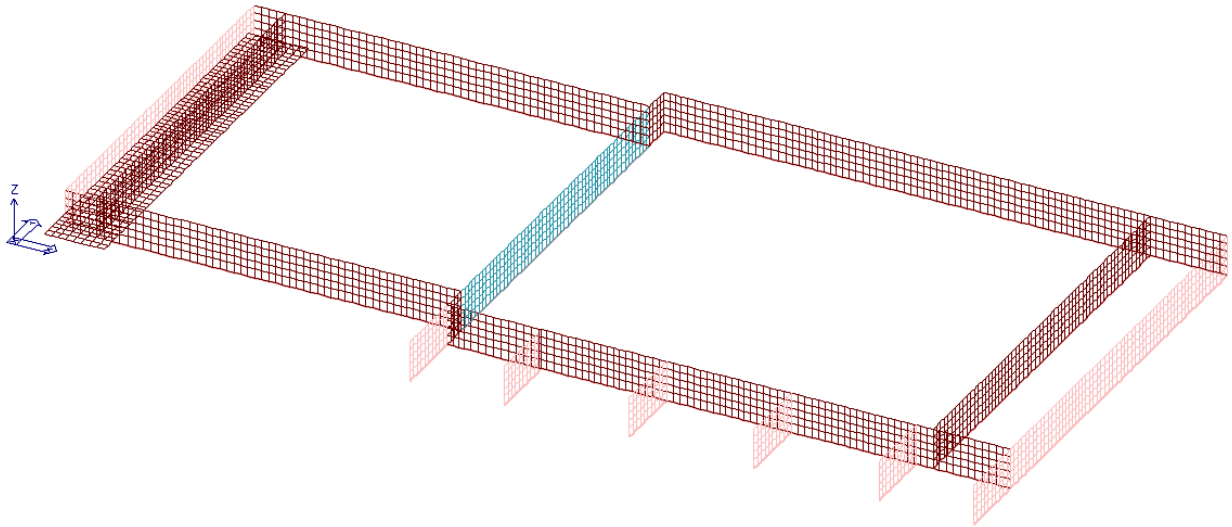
Modello Strutturale Vista unifilare fondazioni - vista assonometrica 1
